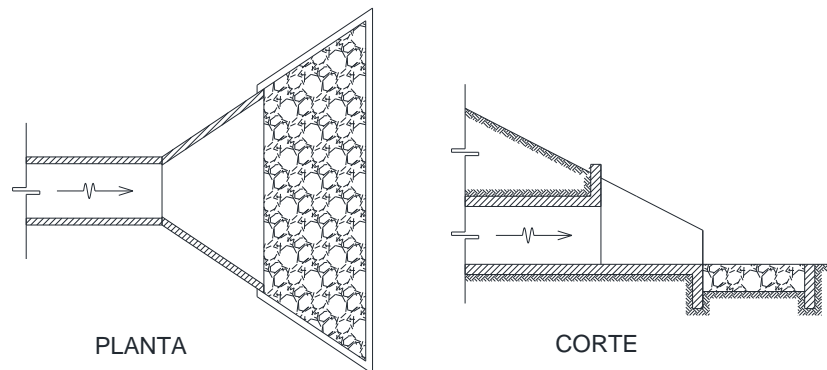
Terminal de alcantarilla con batea de hormigón.
